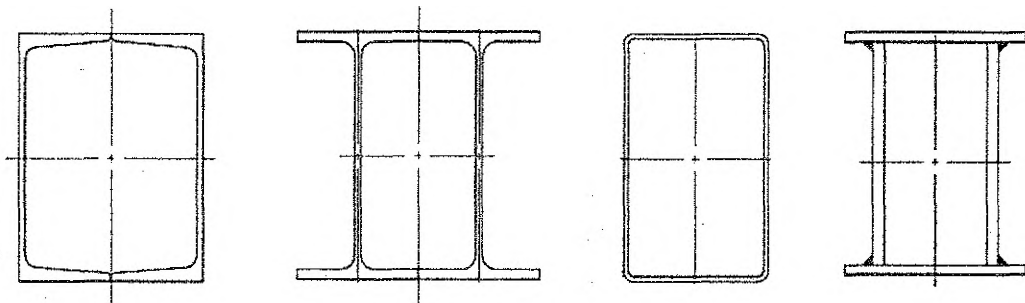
Поперечные сечения балок, для которых не требуется проверка устойчивости по изгибно-крутильной форме
